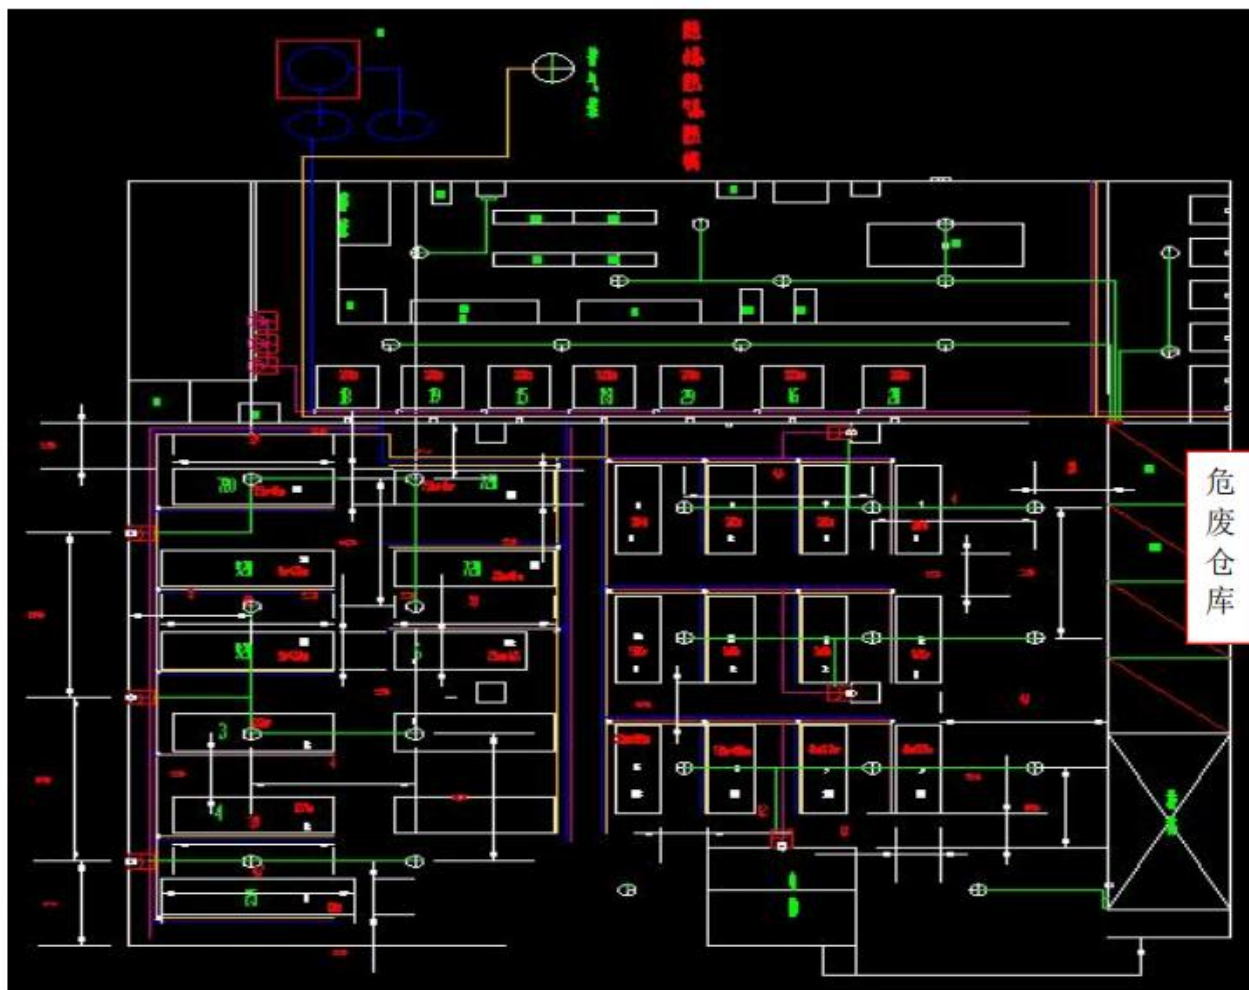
项目 1F 厂房平面示意图 (注塑区、危废仓库)
